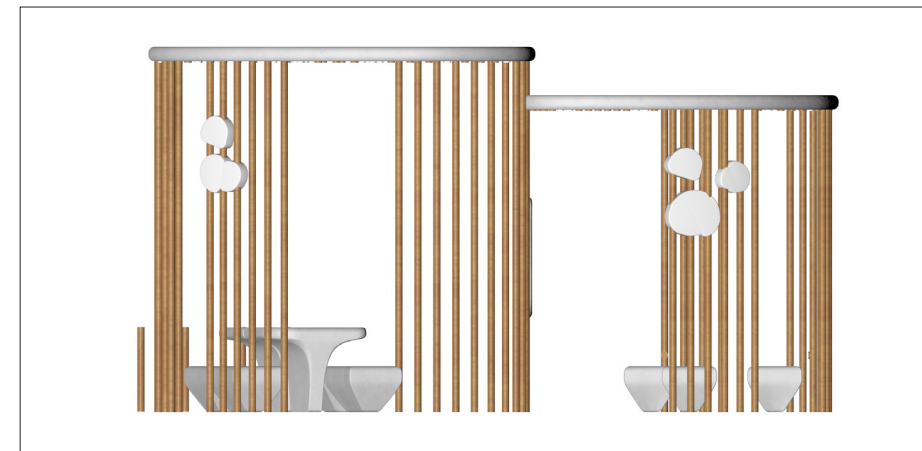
Alzado de la propuesta que ocupa aproximadamente 22m².
